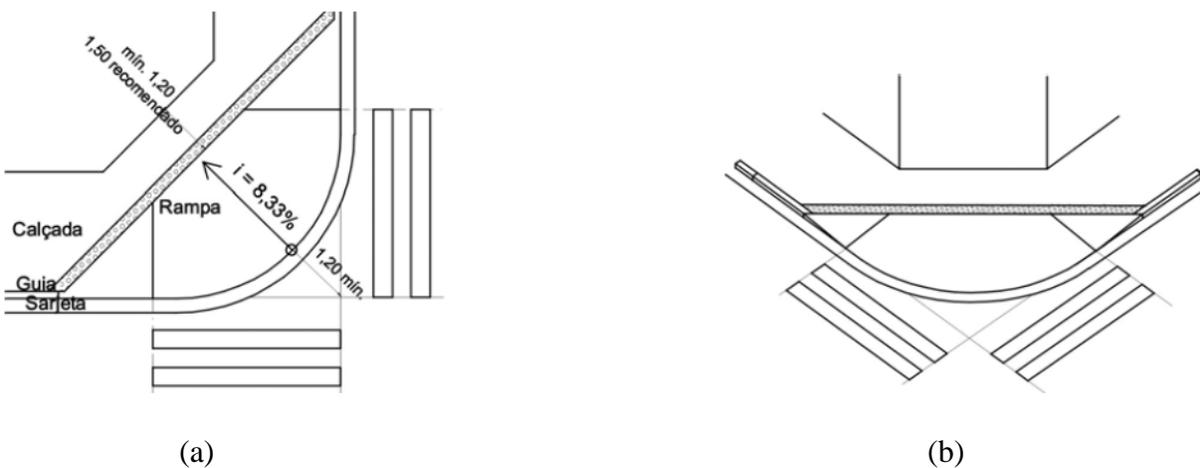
Rebaixamento de calçadas com faixa de pedestres alinhadas com calçada da via transversal.
